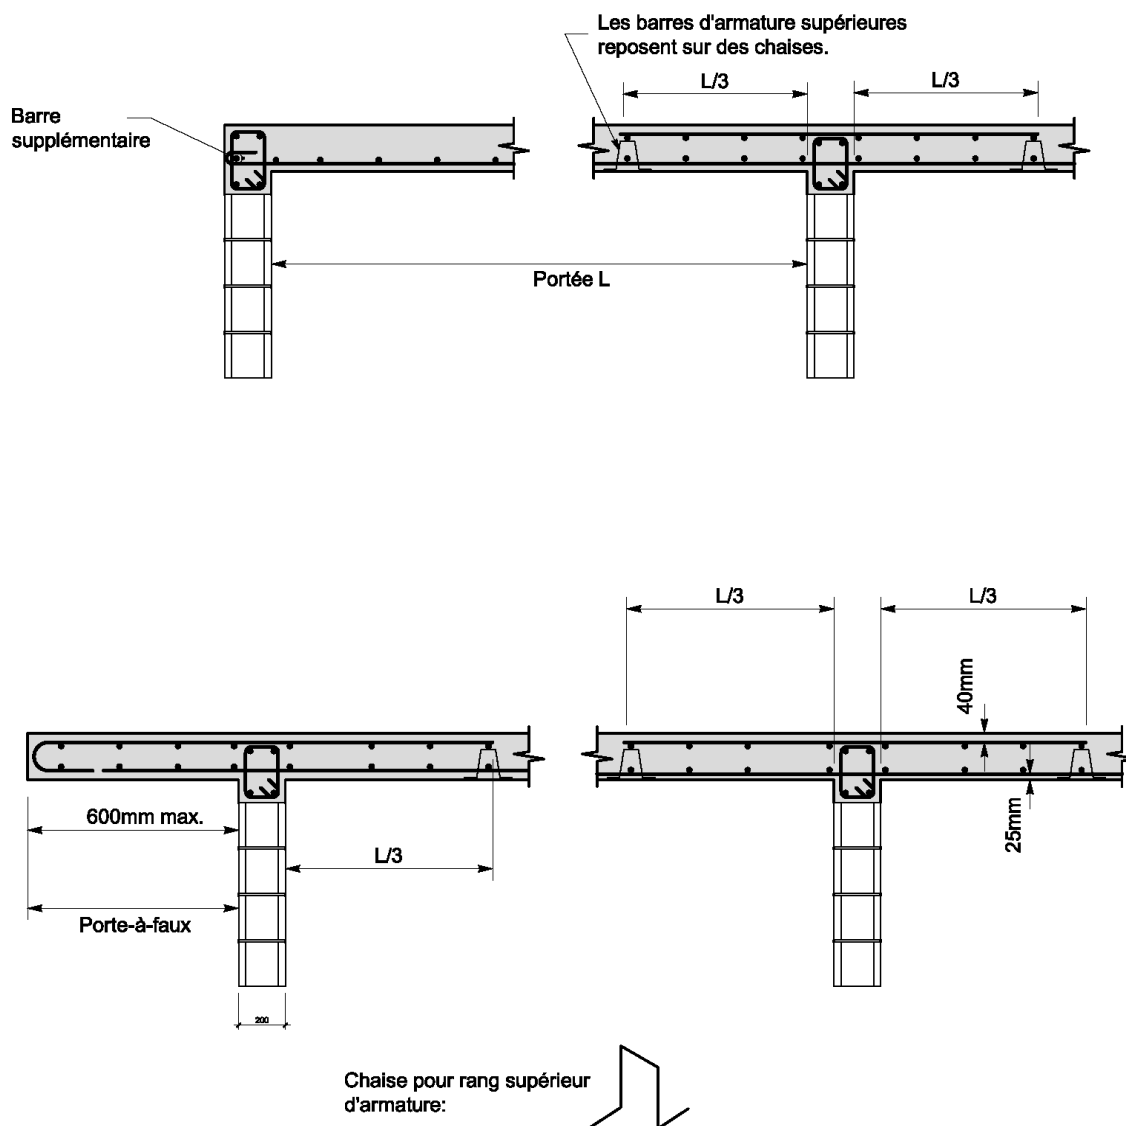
Armature d'une dalle à portée continue
